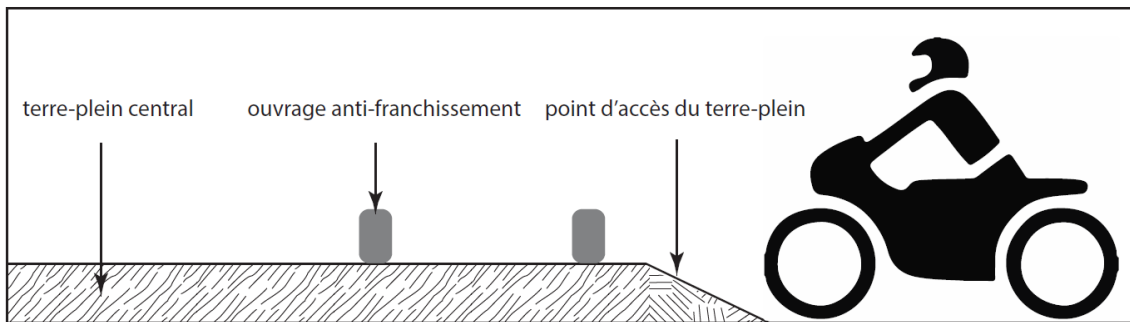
Coupe projet anti-franchissement d'un terre-plein
